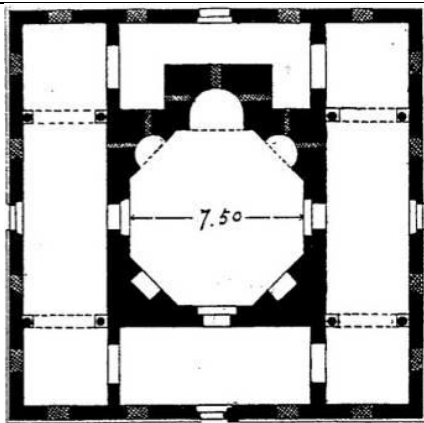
المسقط الأفقي لجامع رستم باشا في إستانبول:
